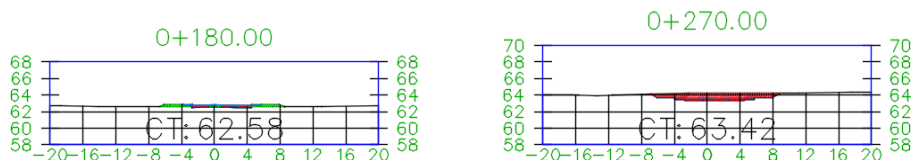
Secciones de una calle, en verde sector a rellenar y en rojo zona a cortar.
